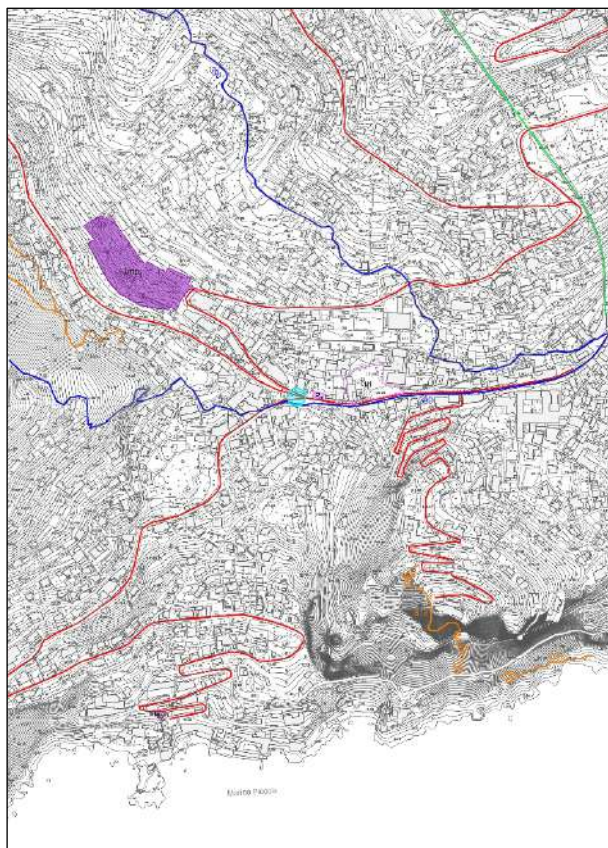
Stralcio della tavola delle infrastrutture in cui si evidenzia in azzurro la zona interessata dall'ampliamento della sede stradale
